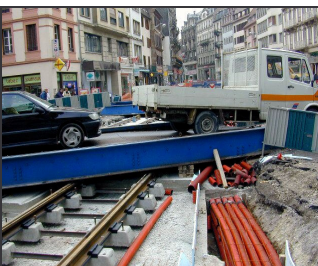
Behelfsbrücke über eine im Bau befindliche Straßenbahntrasse
